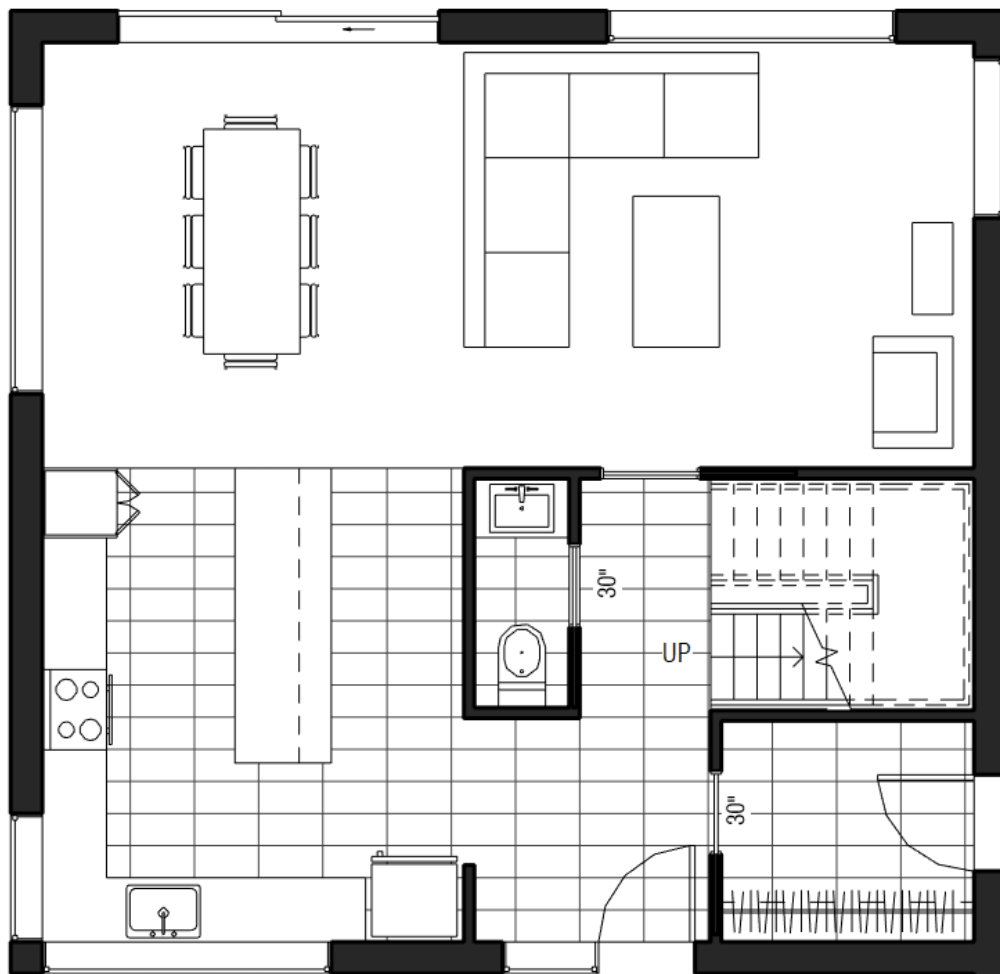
вигляд типу Floor Plan в Autodesk Revit
